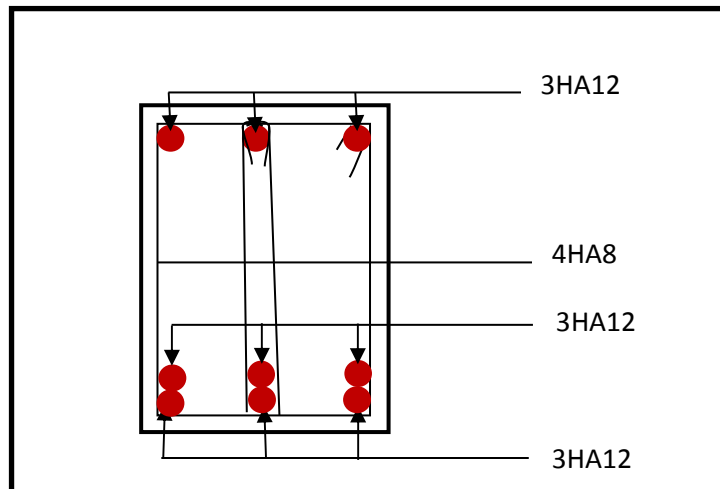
Ferrailage en travée d'une poutre secondaire.
